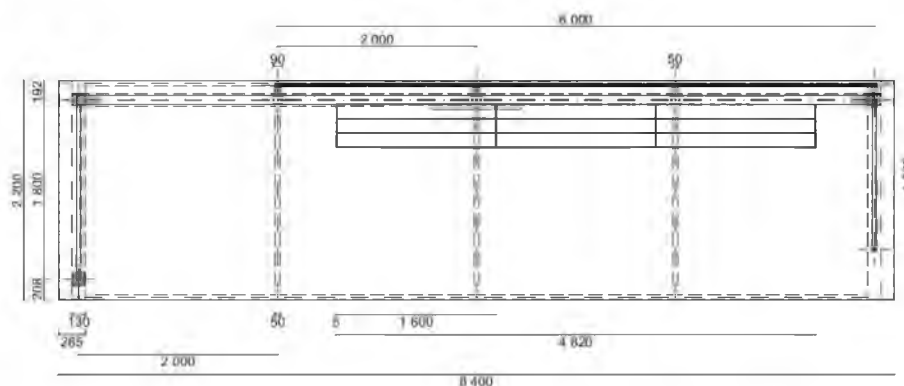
Креслення запроєктованої металоконструкції для великої зупинки (розроблено автором)
